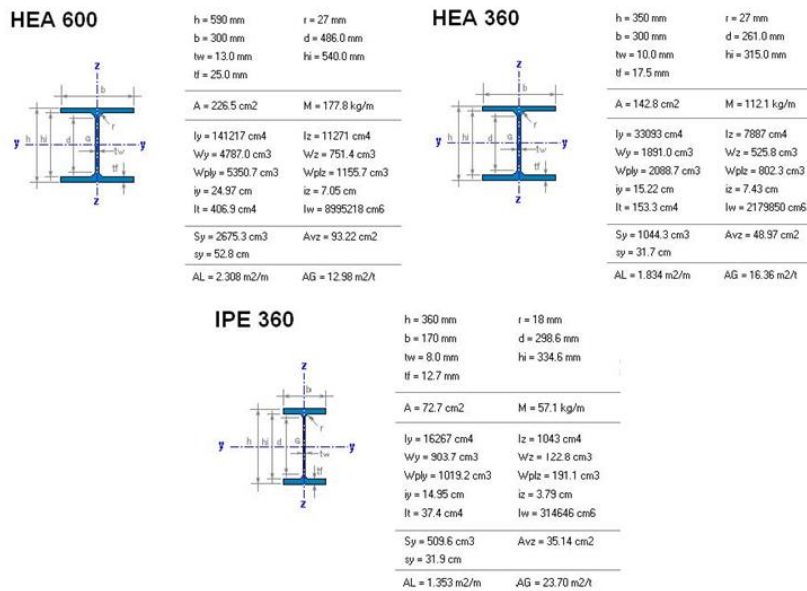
Sección típica de viguetas Piso 2 – Piso 14 (N + 3.20 al N + 66.0)
